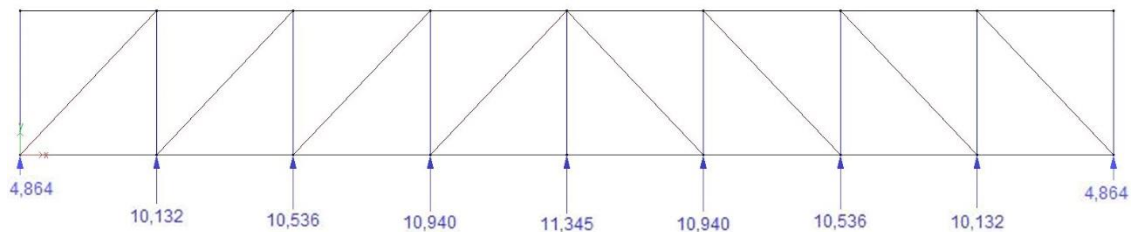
Representação das cargas aplicadas sobre o contraventamento da cobertura.
